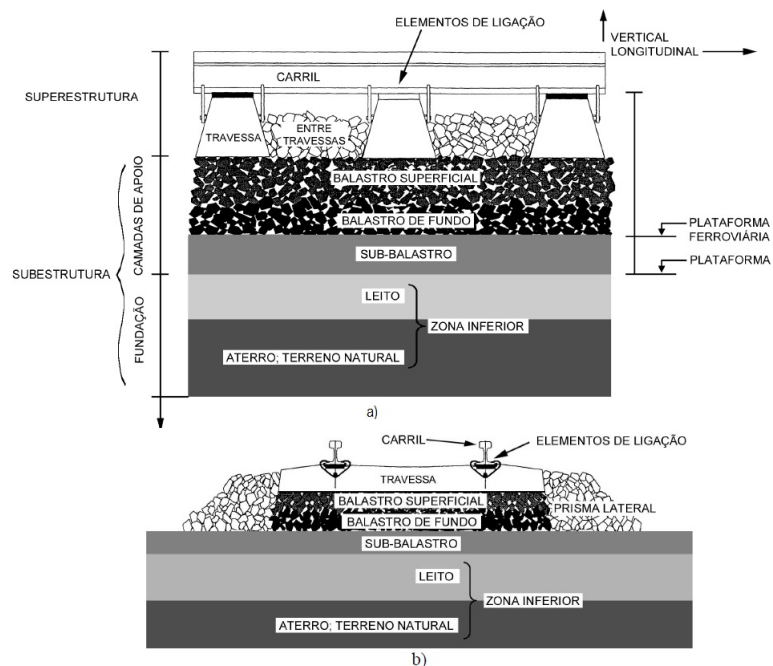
Estrutura da via balastrada - a) Perfil Longitudinal b) Perfil Transversal (Fortunato, 2005).
